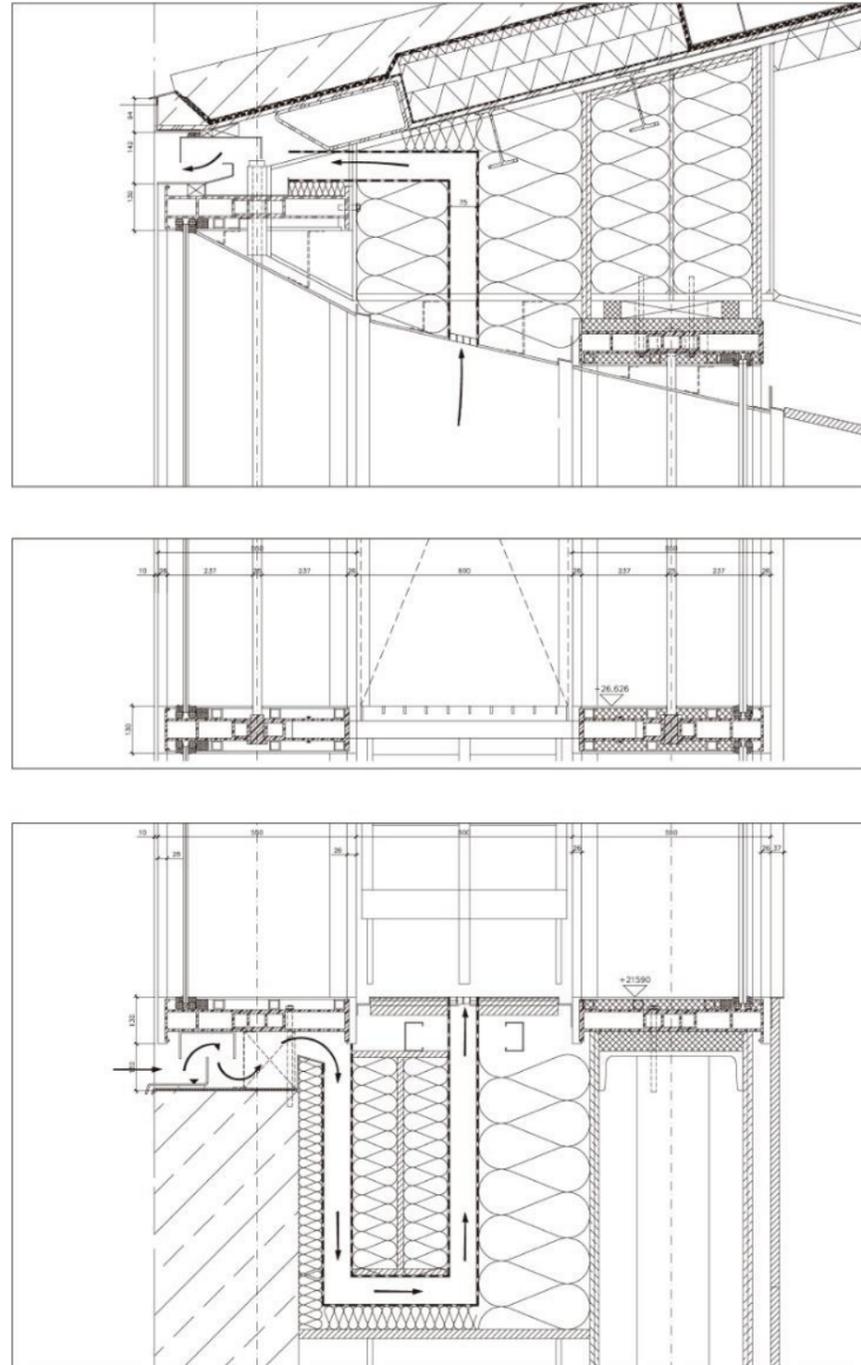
Sección constructiva de una doble cámara de muros de vidrio ondulado. Dimensiones del travesaño y el arriostramiento de estos
